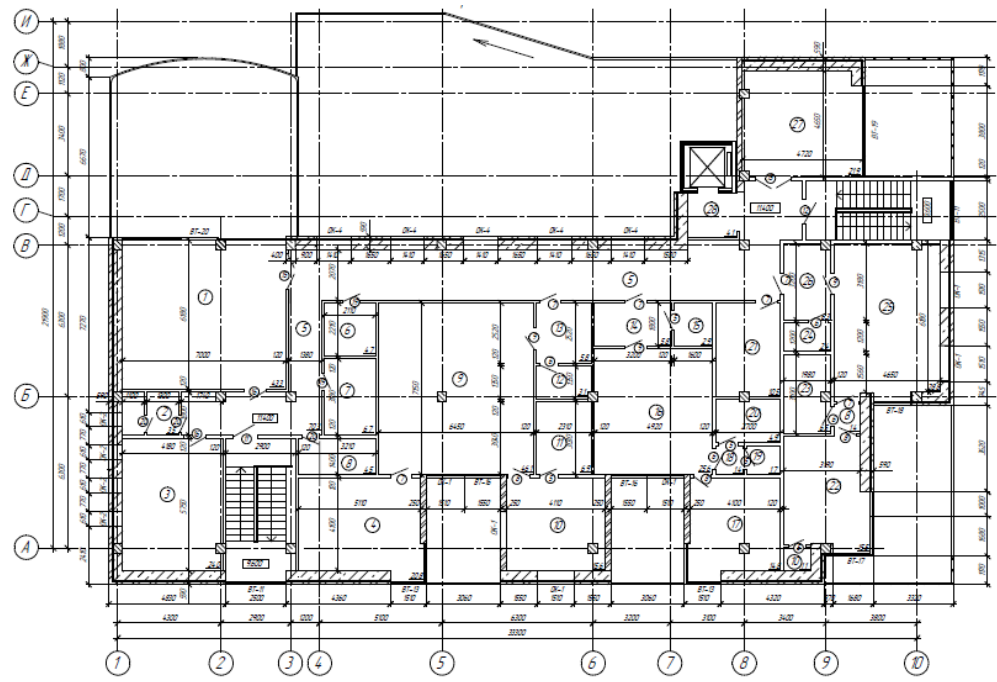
План четвертого этажа на отметке плюс 11.400
